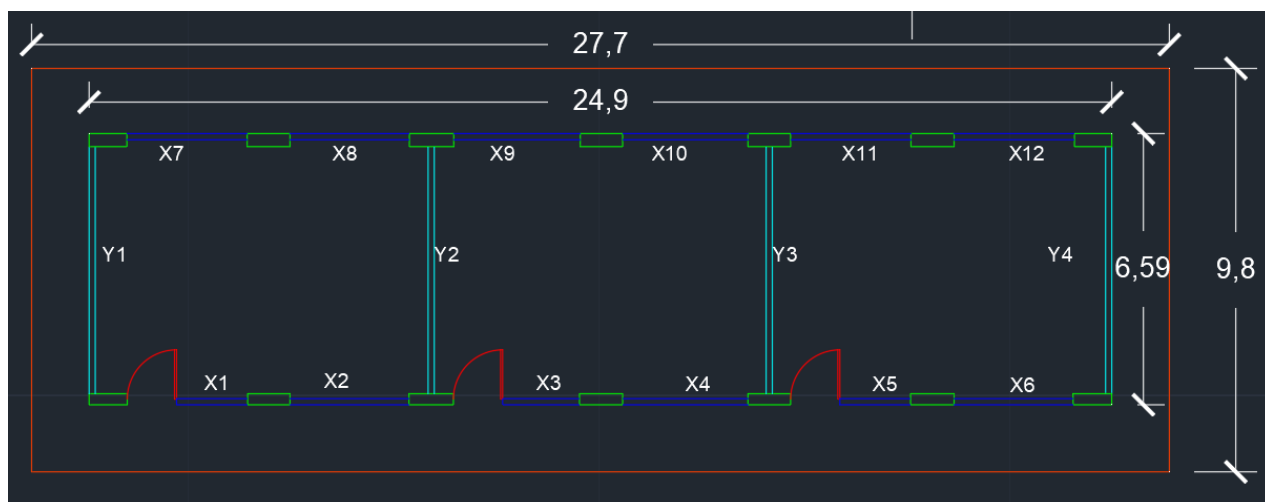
Plano en planta del pabellón A. Fuente: Elaboración propia
